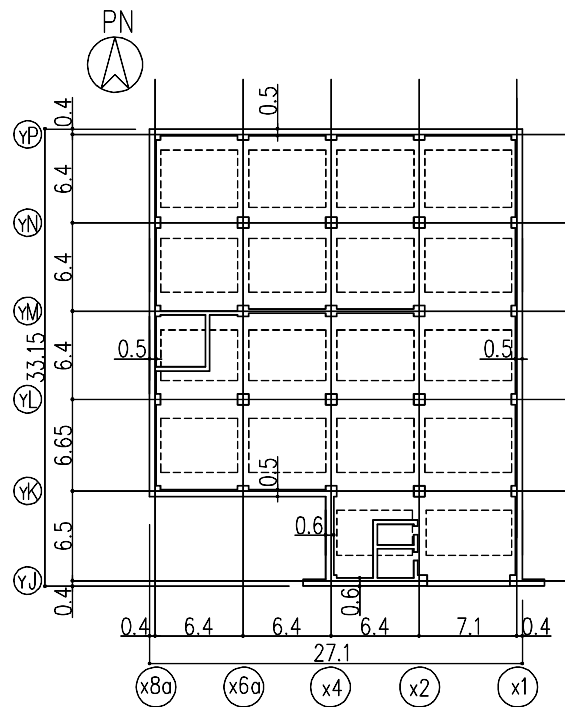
地下2階平面図 (G.L. -8.7) (単位 : m)
